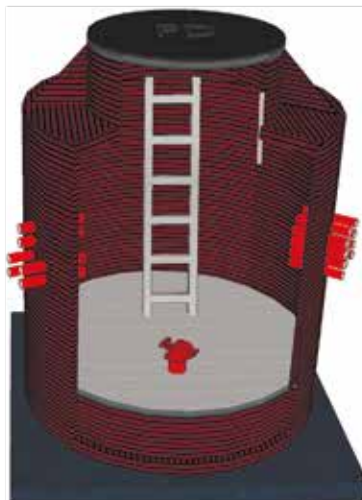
Типовой сварной кабельный колодец FD с шахтой FD SVT
